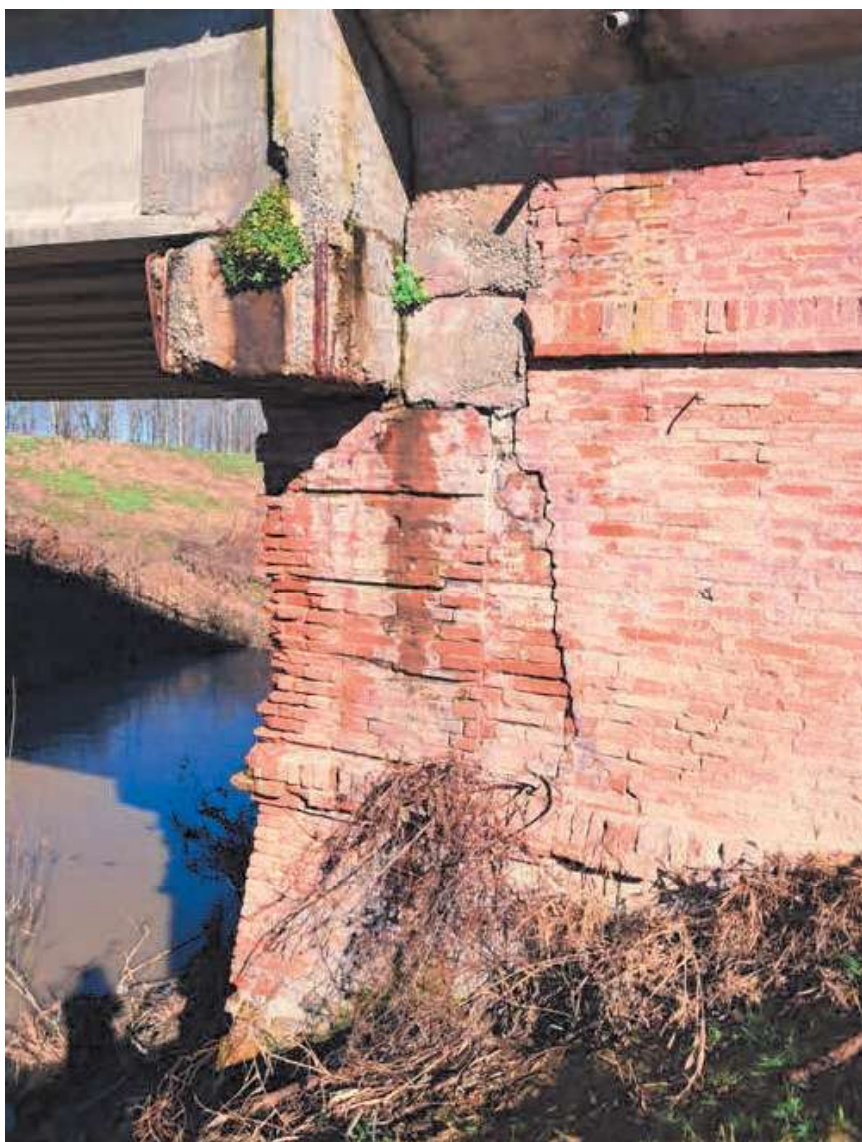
Ponte sul Crostolo (dettaglio spalla e trave pulvino sponda idraulica di destra)
